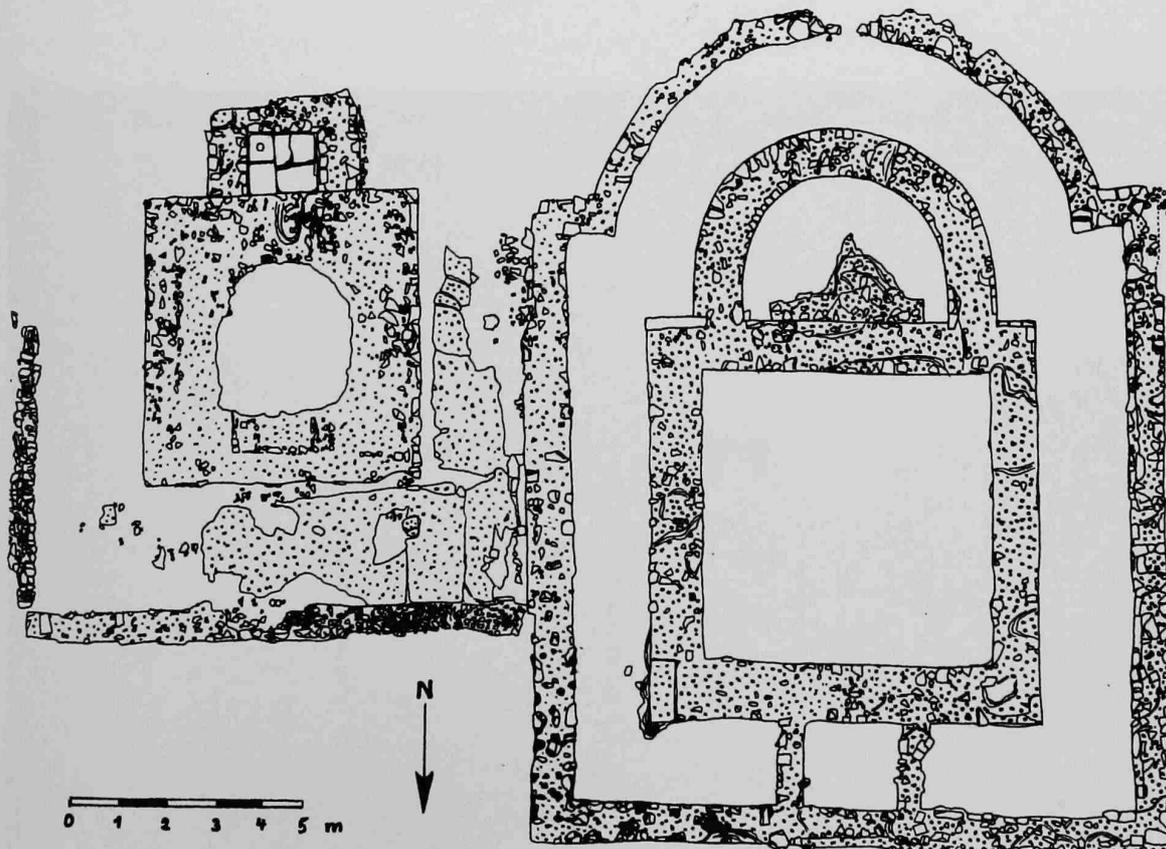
Planta (provisória) do edifício da construção central da Quinta de Marim, elaborada por D. Graen.
